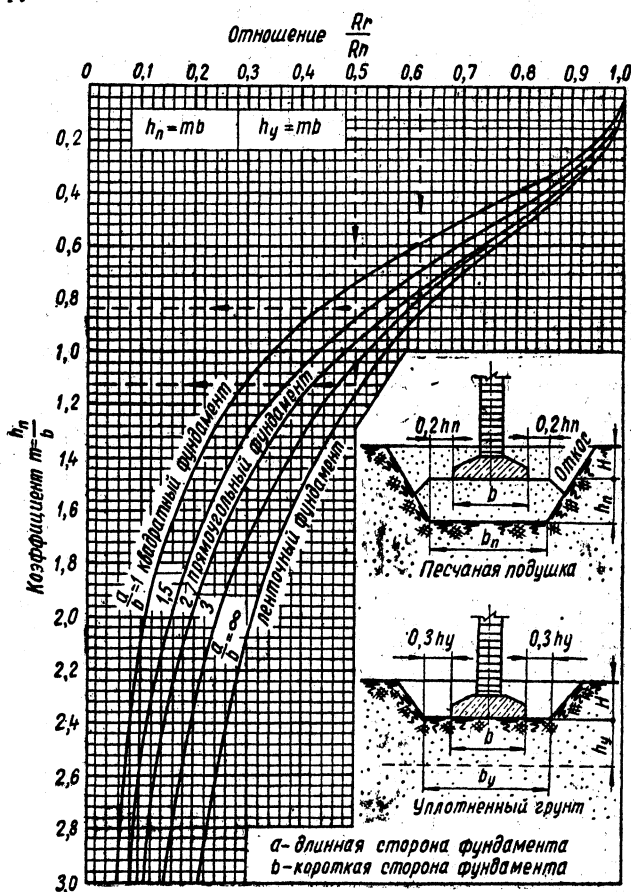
График для определения коэффициента m , толщины песчаной подушки h_n или глубины уплотнения слабого слоя грунта h_y под подошвой фундамента.
